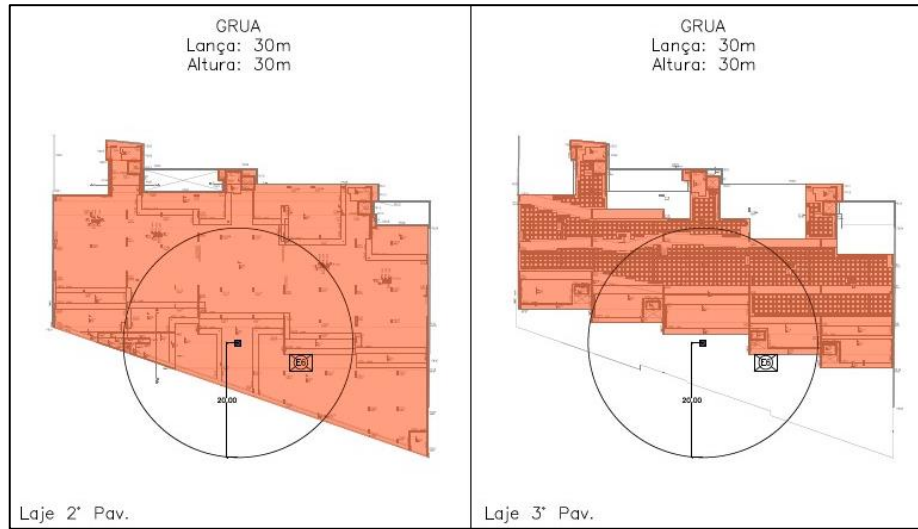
Croqui com a posição da grua e do elevador cremalheira
